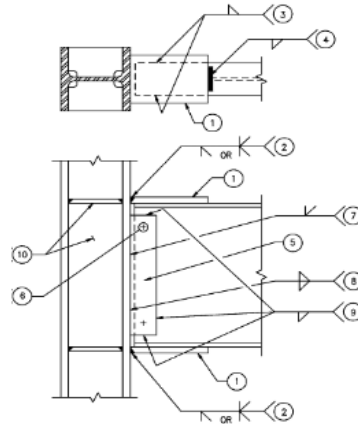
Conexión soldada con cubre placa. (Welded
